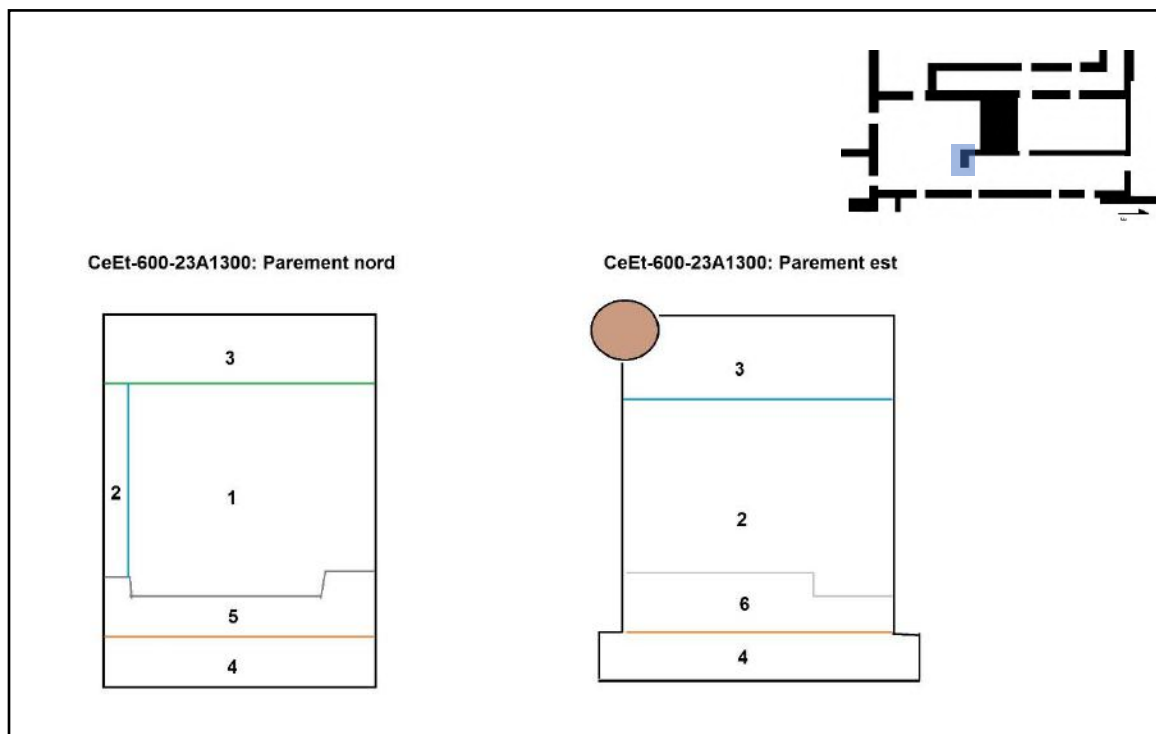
Croquis des modes de construction observés sur les parements nord et est du mur CeEt-600-23A1300.
